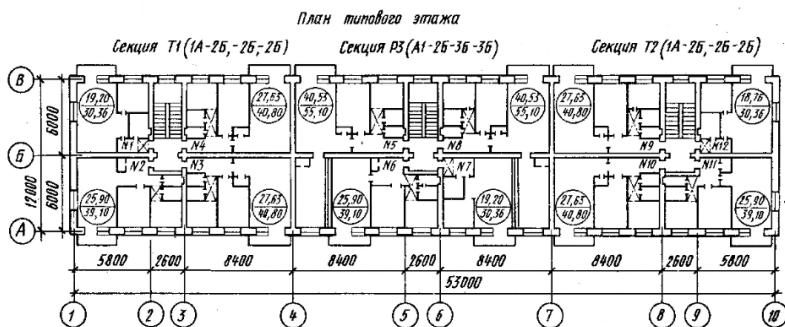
План типового этажа пятиэтажного жилого дома
